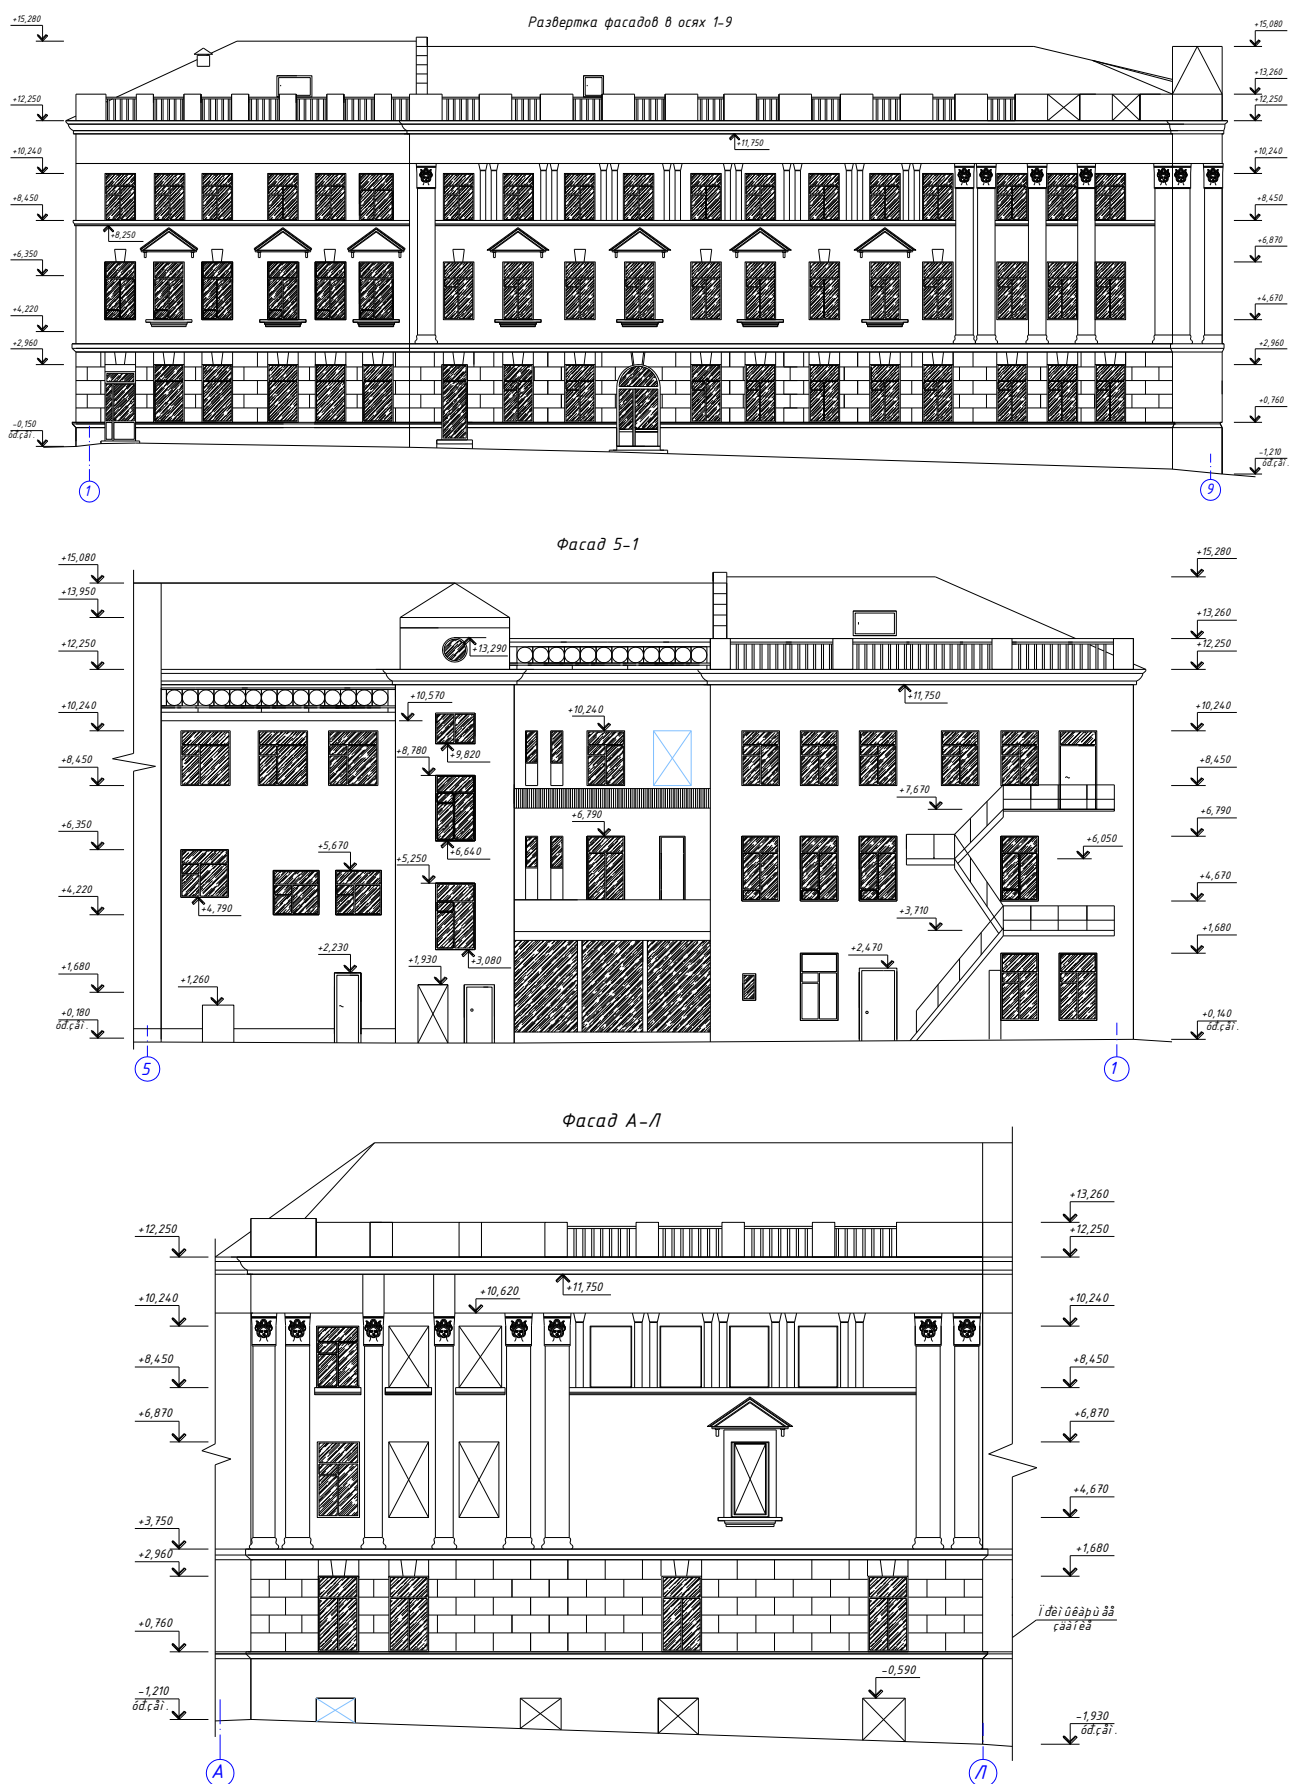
Схема фасадов 3-этажного здания в г. Ростов-на-Дону
